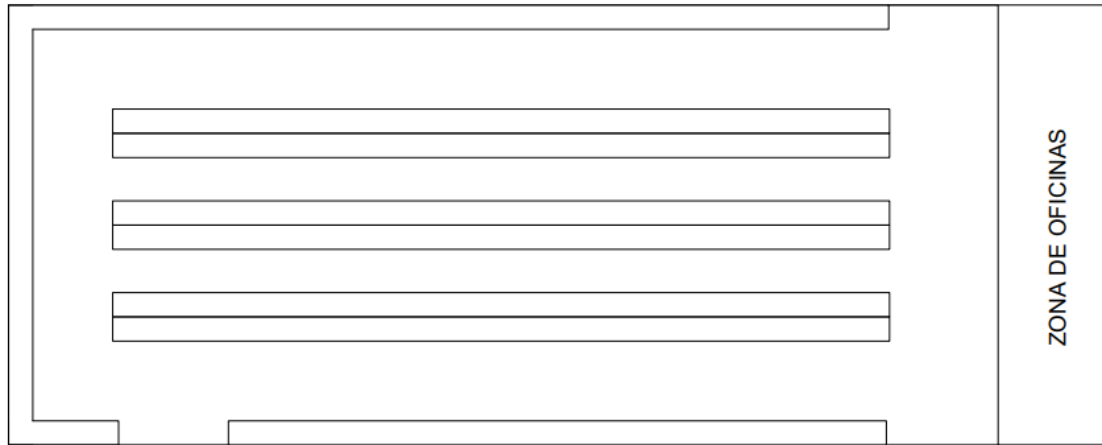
DISTRIBUCIÓN PLANTA-PLANO AUTOCAD
